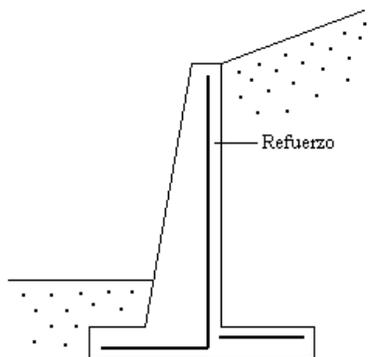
Muro Cantilever (Rojas Martínez, 2009).
